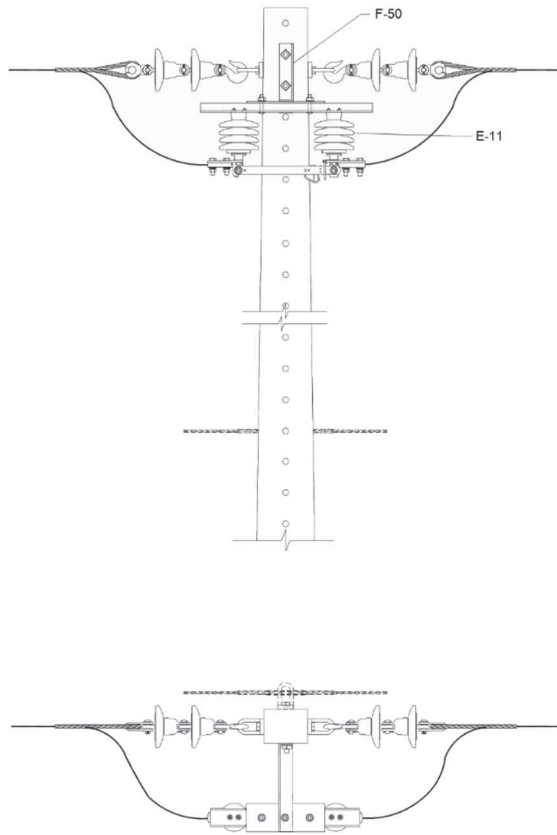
Instalação de equipamentos – Seccionador unipolar – Estrutura monofásica
